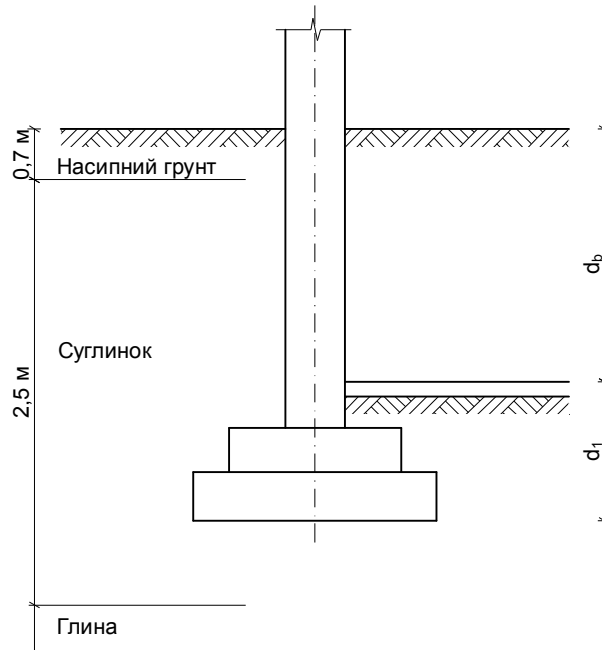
Схема розміщення фундаменту у ґрунті
